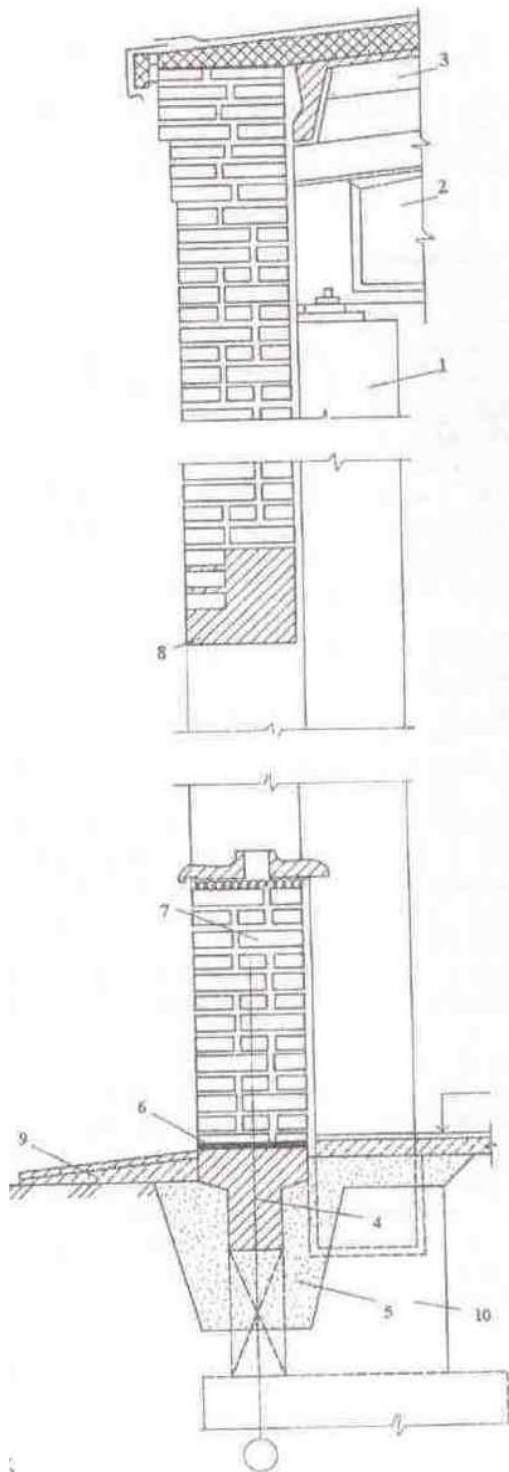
Зовнішня самонесуча цегляна стіна з карнизом: 1 – залізобетонна колона; 2 – кроквяна балка покриття; 3 – плита покриття; 4 – фундаментна балка; 5 – шлакове підсипання під фундаментну балку; 6 – горизонтальна гідроізоляція; 7 – самонесуча цегляна стіна; 8 – залізобетонна перемичка; 9 – вимощення; 10 – стовпчастий фундамент
